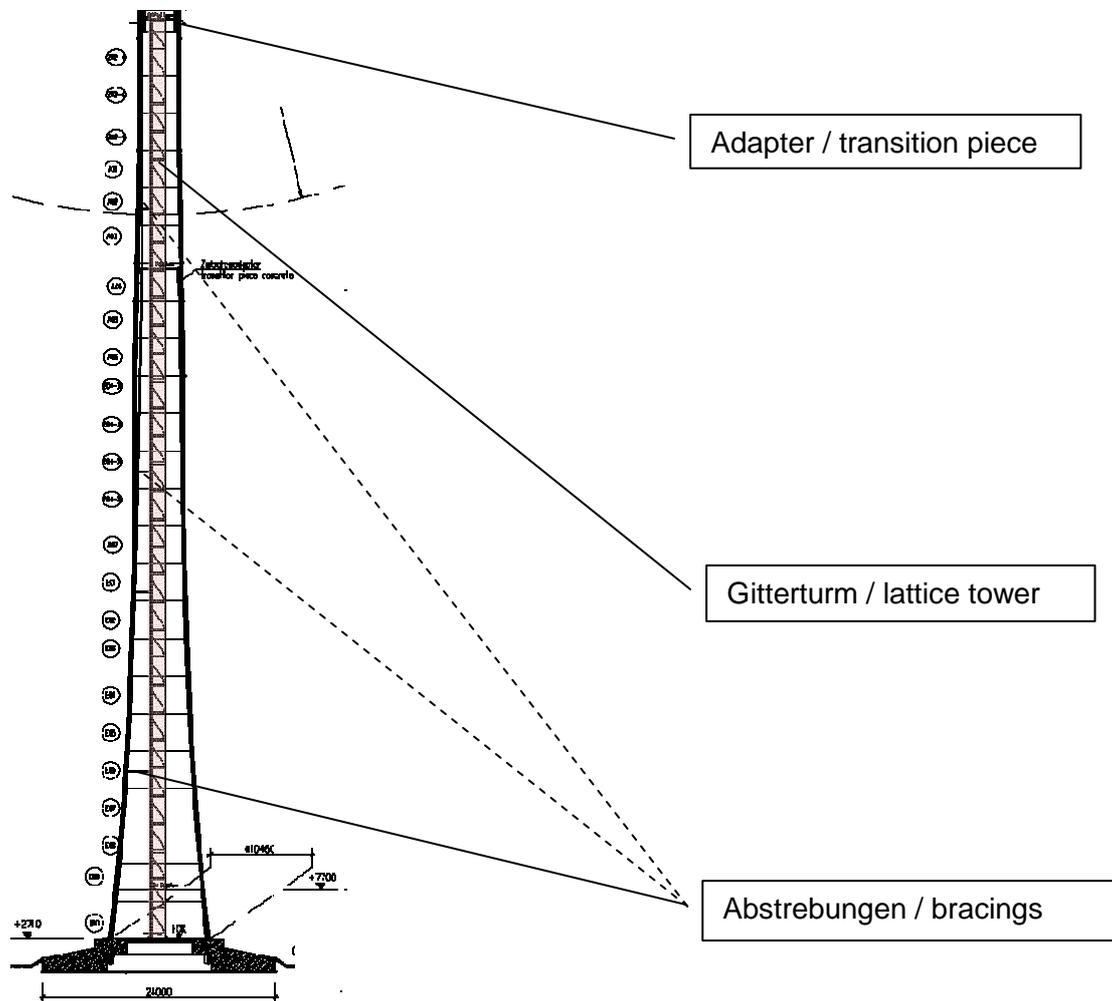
Übersicht Inneneinbaukonzept Betonturm / overview internals concrete tower
